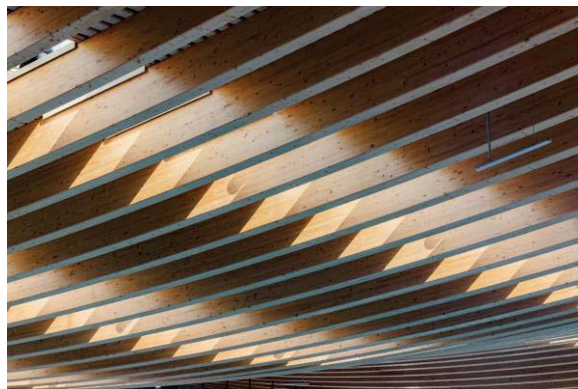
Фрагмент деревянных клееных конструкций крыши здания
